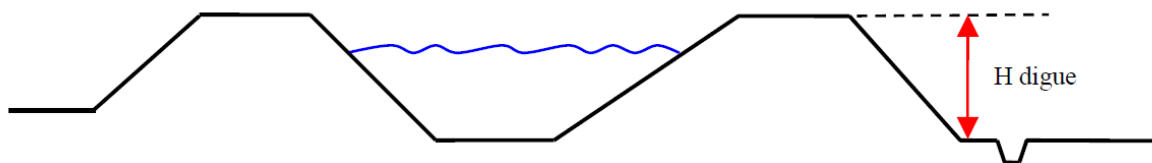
Hauteur H prise en compte dans le cas de digues de canaux (Cemagref 2008)
